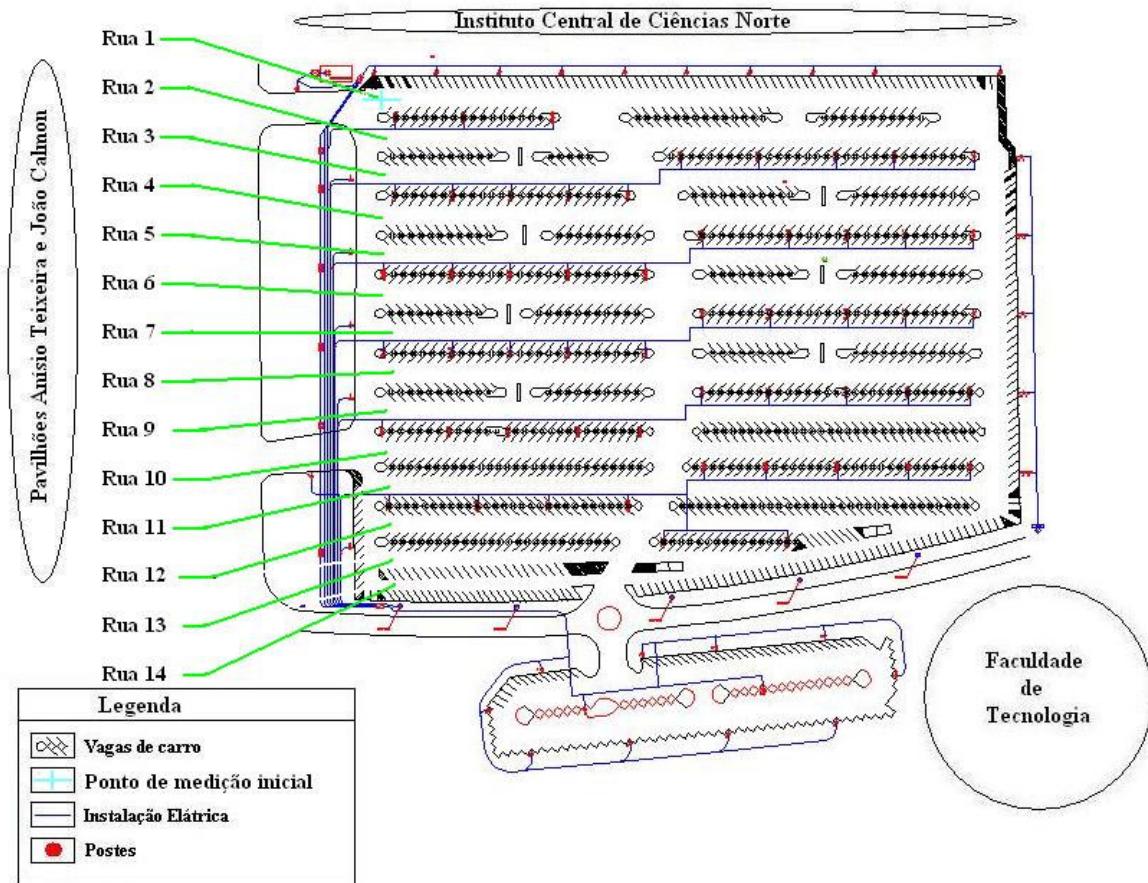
Planta do estacionamento e instalação elétrica do ICC Norte.
